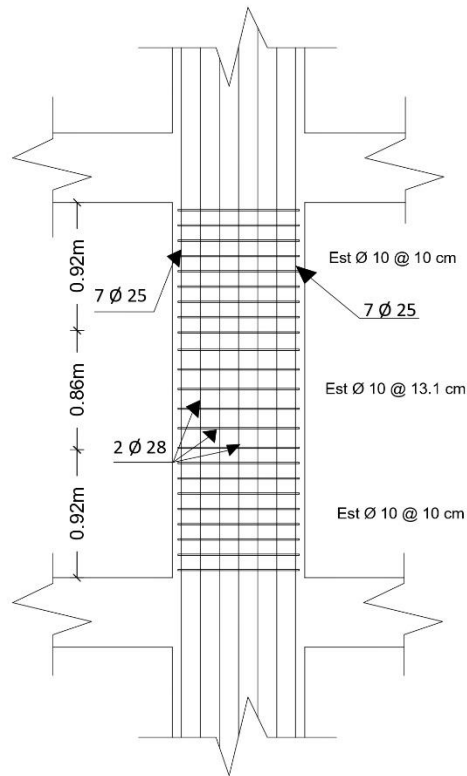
Vista de sección transversal de columna del piso 6 al 11
